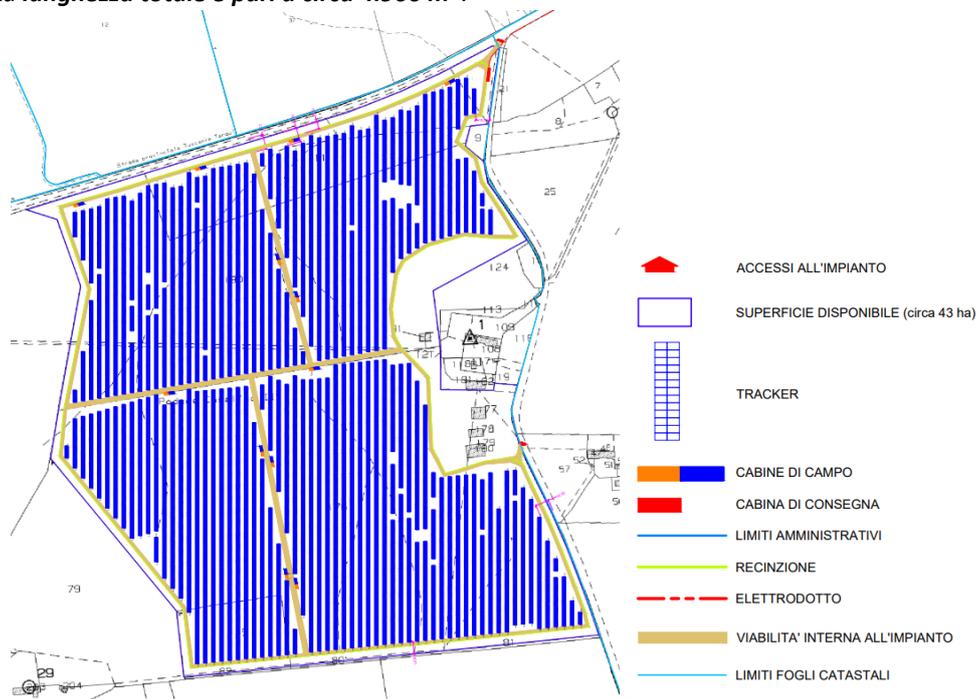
Elaborato di Progetto - Layout di Impianto (cfr. impianto su base catastale ELAB.28)
